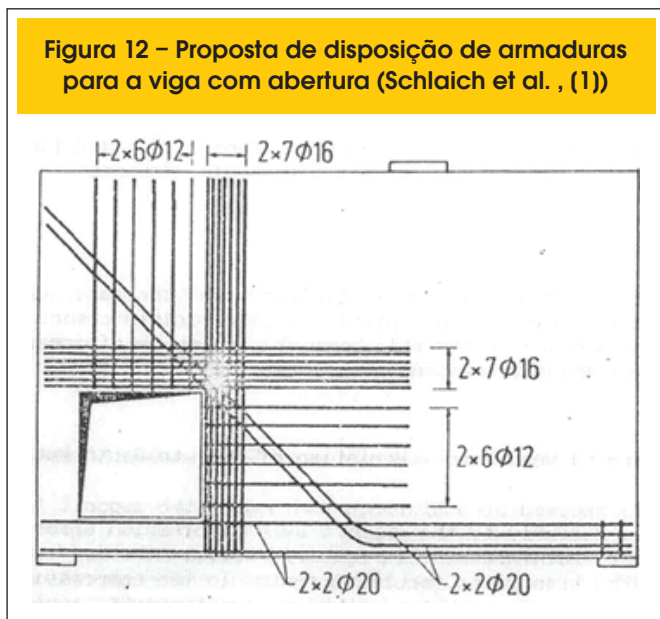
Proposta de disposição de armaduras para a viga com abertura (Schlaich et al., (1))
